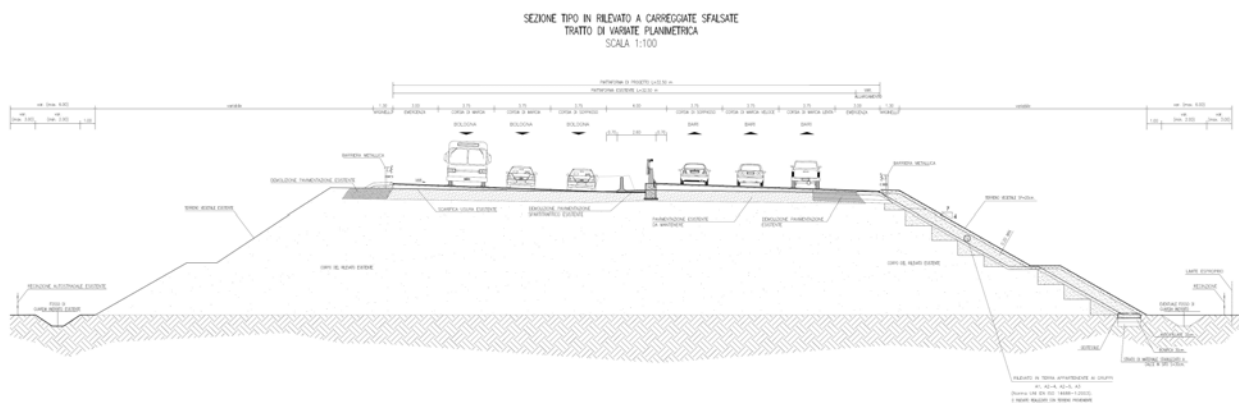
Sezione tipo in rilevato a carreggiate sfalsate – tratto intermedio
